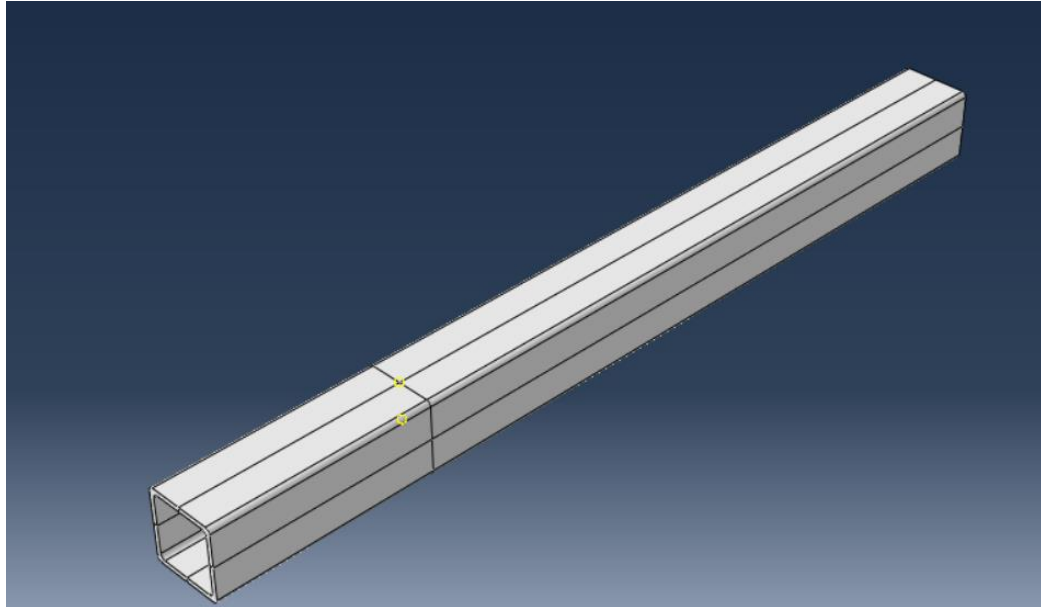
Extrusión ya particionada del pilar con perfil cuadrado
